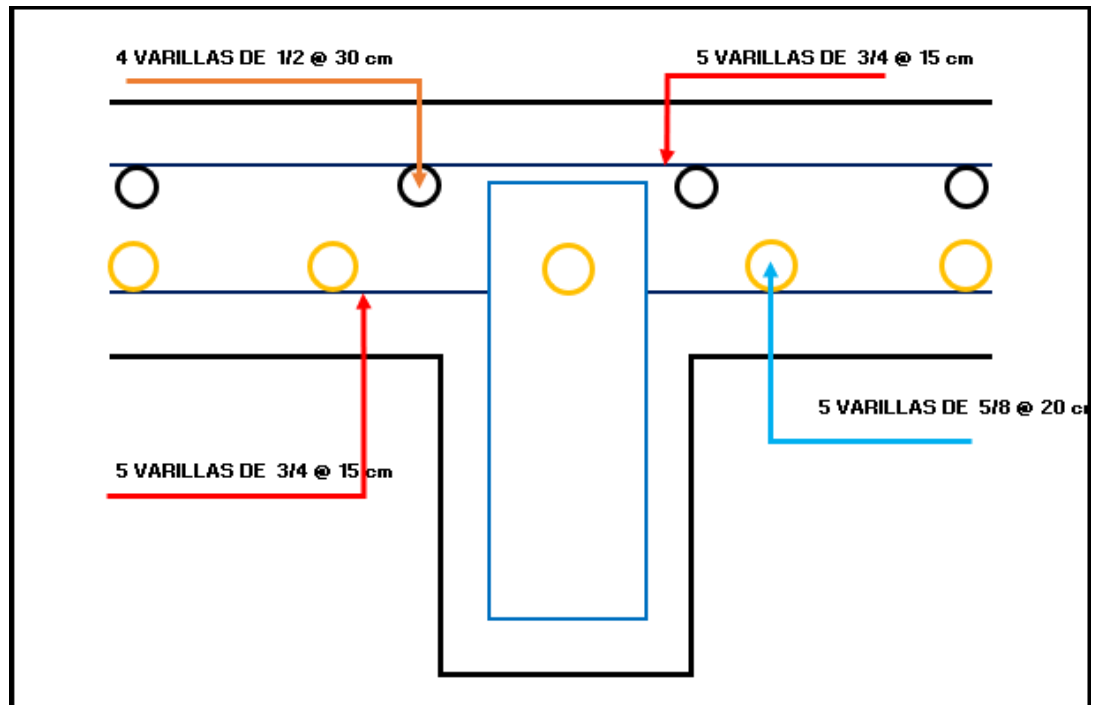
SECCION FINAL LOSA-FUENTE: ELABORACION PROPIA
